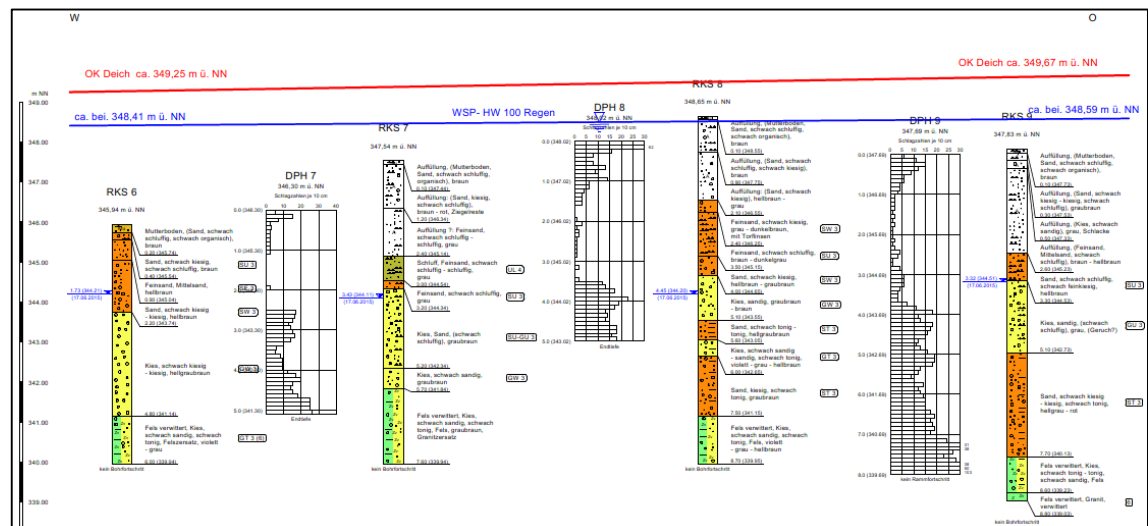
Schnittprofil Anlage 5.4, gemäß Baugrundgutachten
